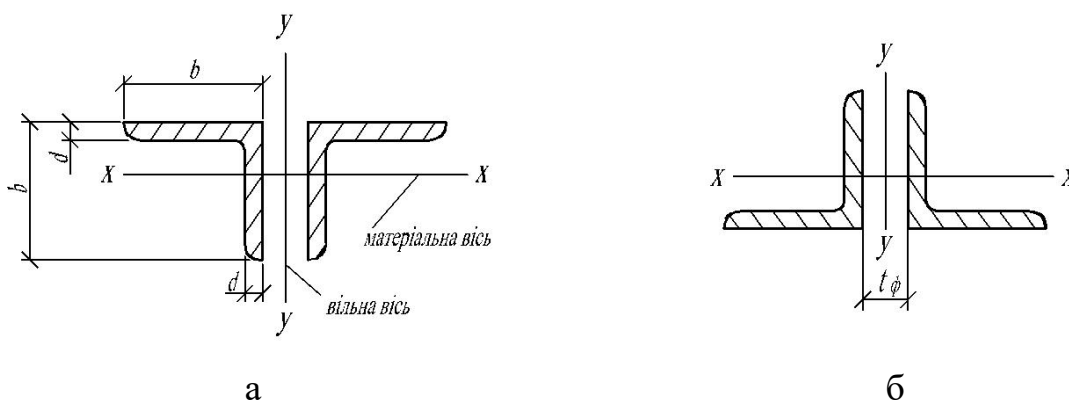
Поперечні перерізи елементів ферми: а – для всіх елементів ферми, крім нижнього поясу; б – для елементів нижнього поясу
